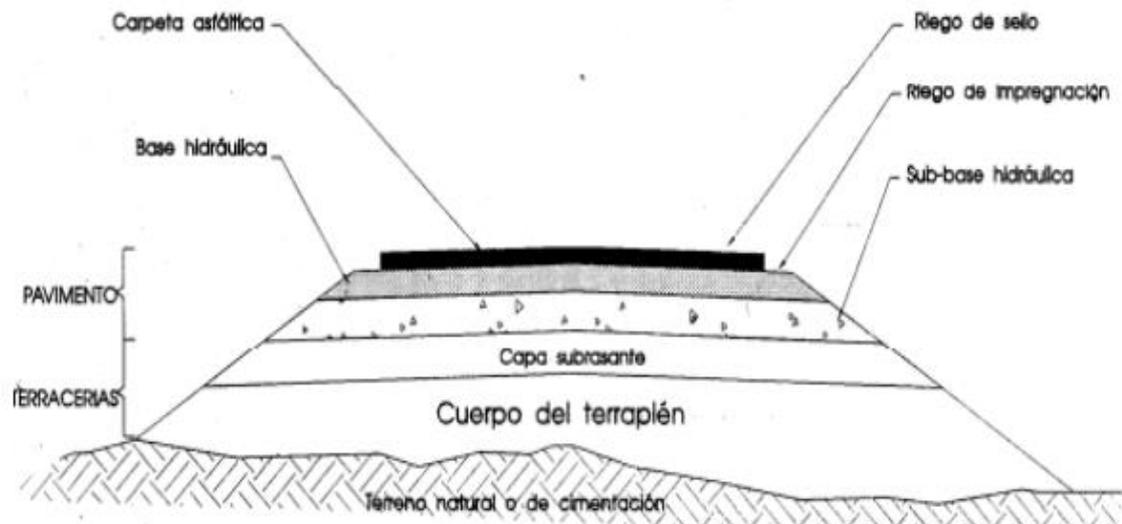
Perfil típico de una estructura de pavimento flexible.
